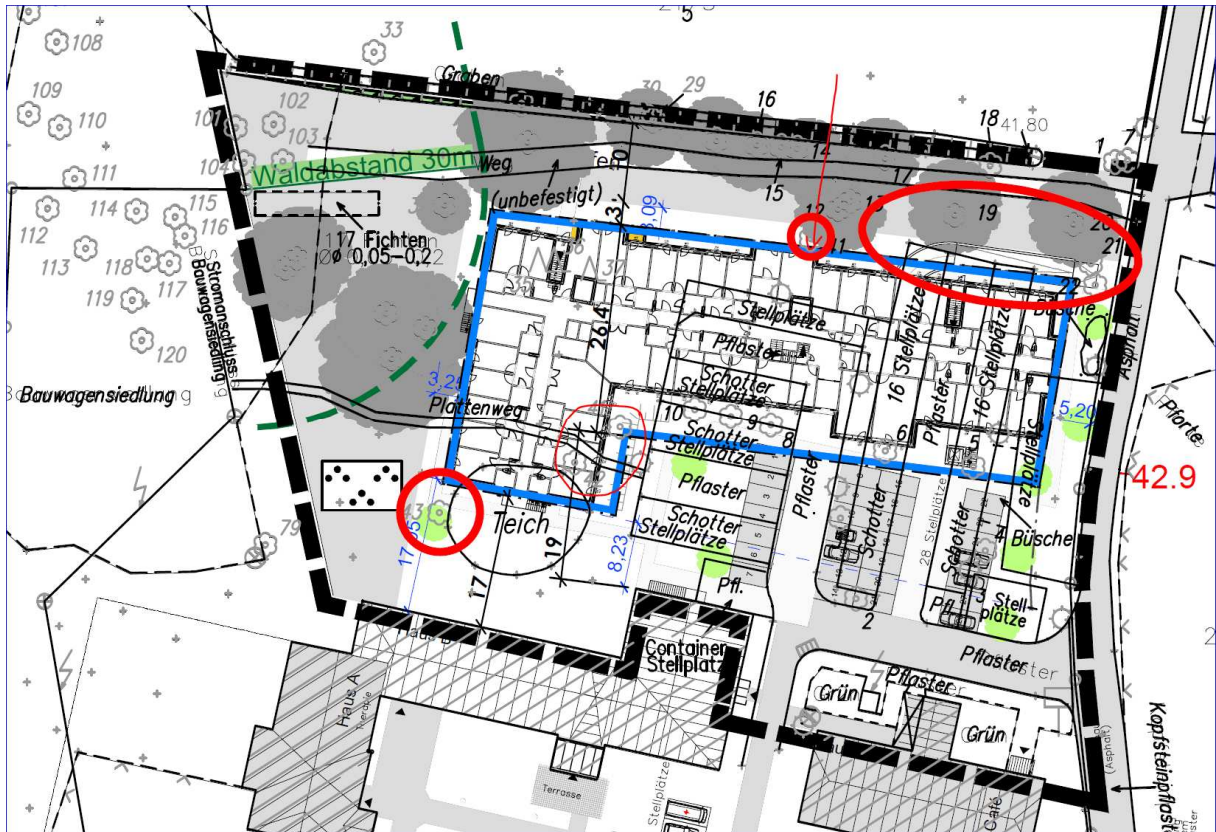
Gut Wienebüttel „Planfläche“ mit rot markierten Bereichen betroffener Bäume
